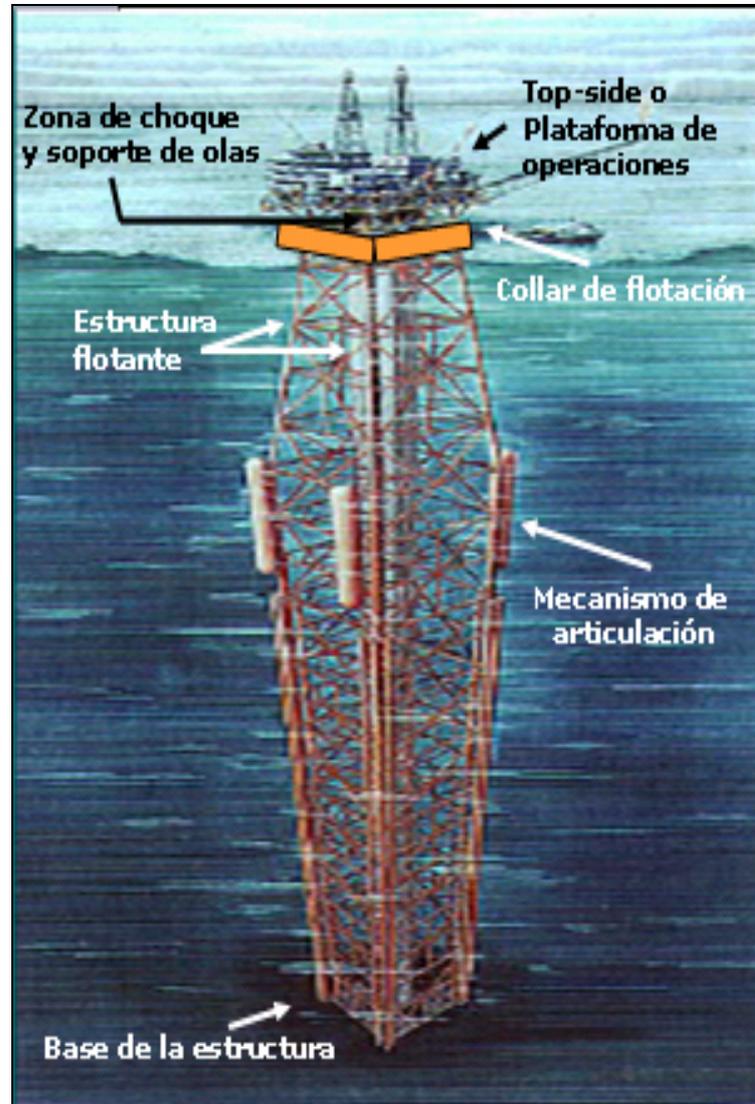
Configuración de la plataforma de base flexible o *compliant tower platform (CPT)* ^[15]
